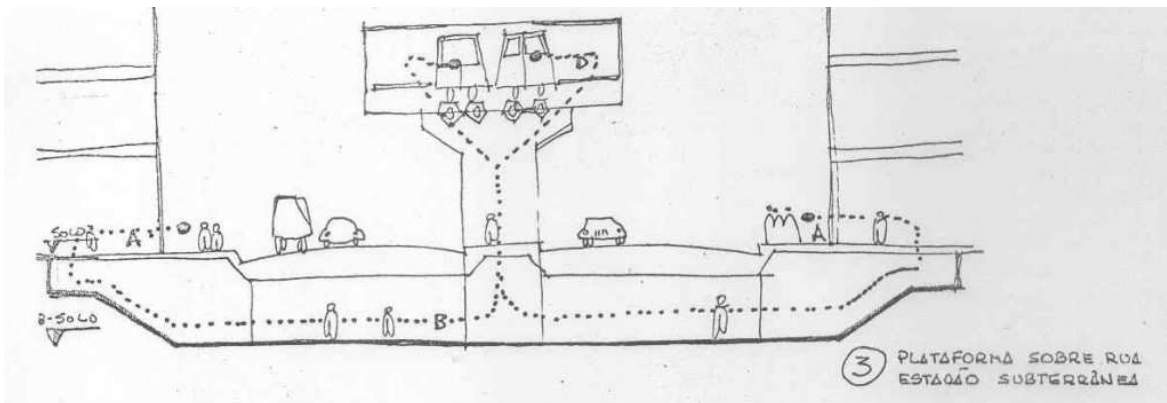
Plano Preliminar do Metrô - estação subterrânea, plataforma sobre rua
